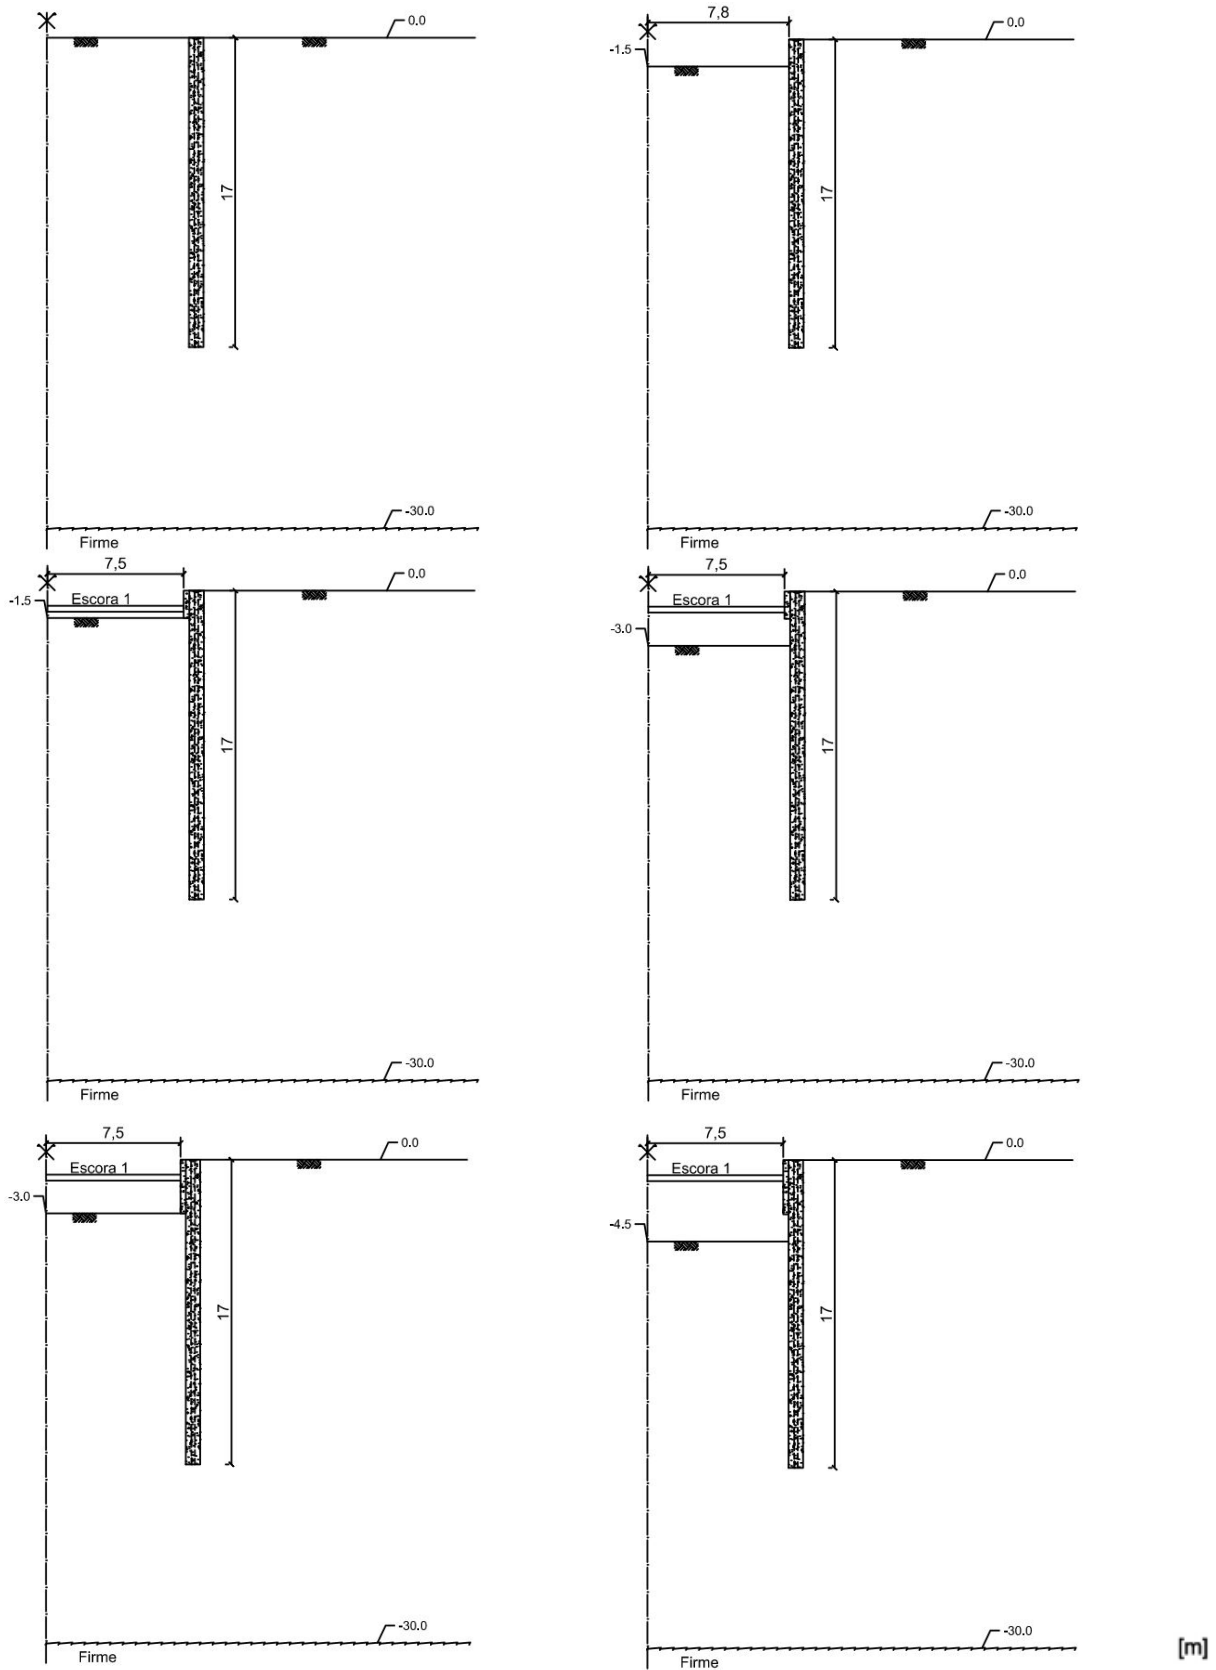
Processo construtivo da obra em estudo até à fase 4,5 m
